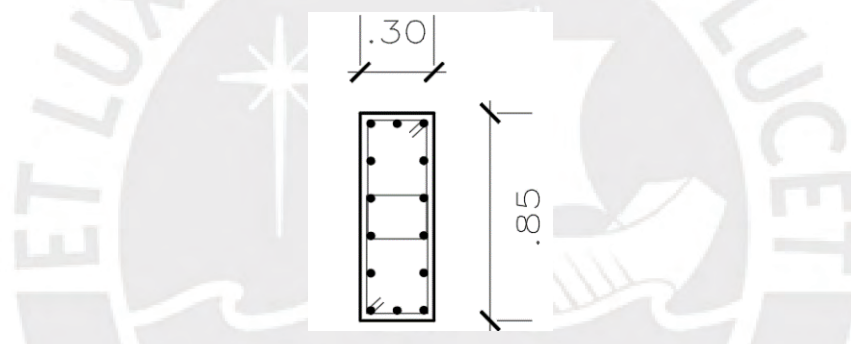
Armado de refuerzo longitudinal para la columna entre los ejes A-2 de sistema dual
